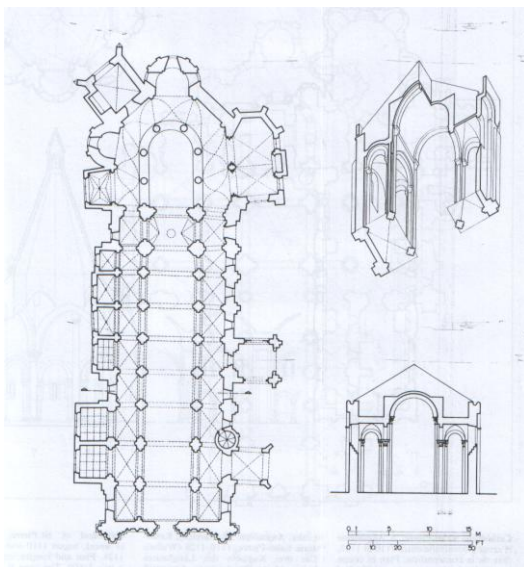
Notre-Dame de Poitiers : plan, coupe et axonométrie Source (Stierlin, 1977, p151)
